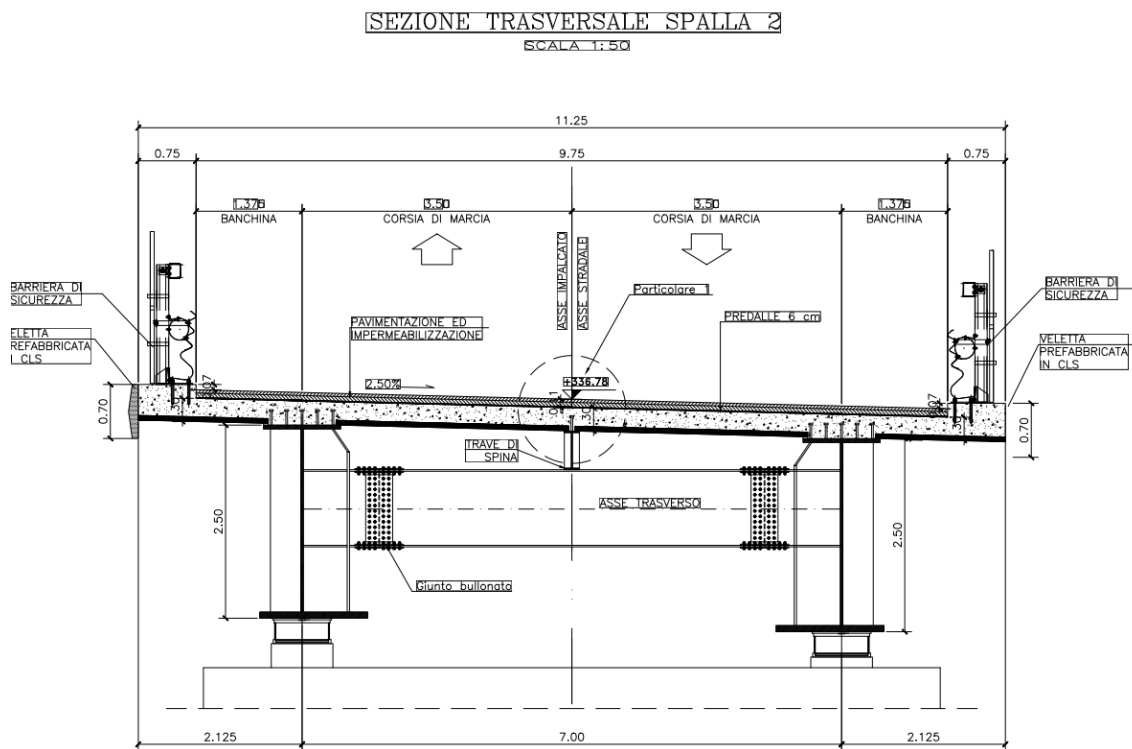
Sezione trasversale dell'impalcato - sezione su spalla S2 (sezione tipo2)
